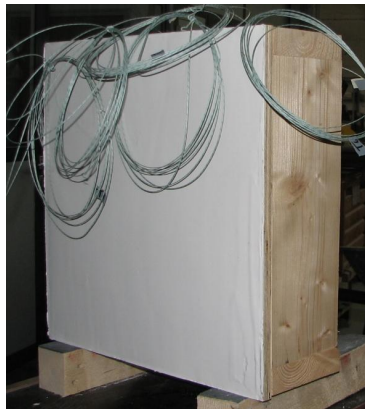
Untersuchung Konstruktionsdetails: Aufbau der Grundkörper [INO09]
